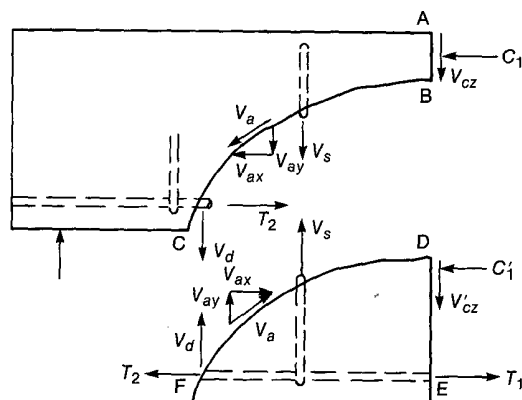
Forças internas em viga fissurada com estribos FONTE: MacGregor, 2005
